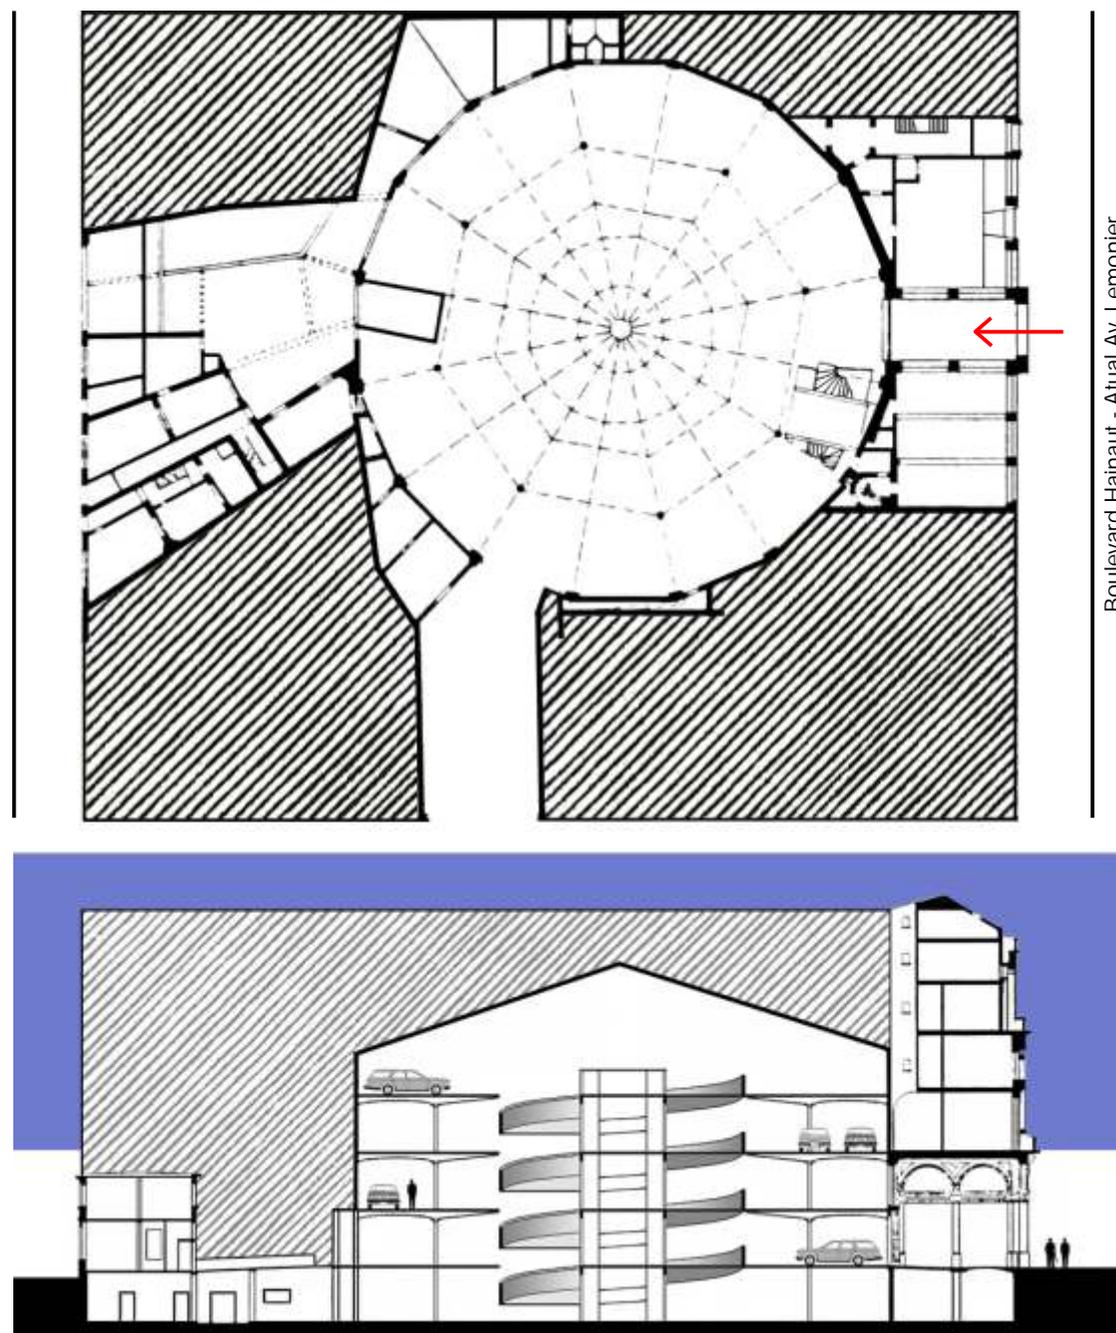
e 40- Planta: Projeção da cobertura e corte longitudinal - Cilindro interior e rampas para os veículos.
